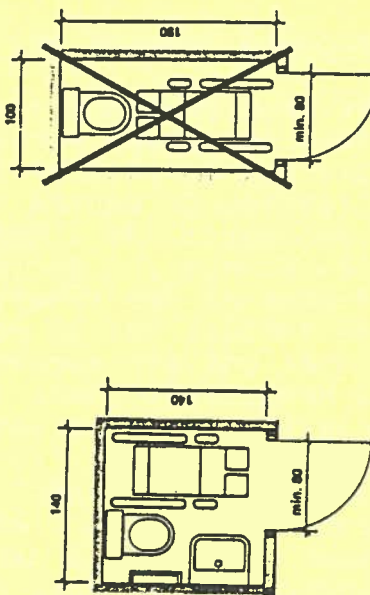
Grundriss einer Toilettenanlage, Minimalanordnung
